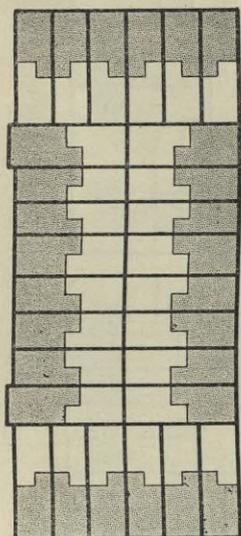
Typus der halb-offenen Bauweise in England, Holland, Bremen.
